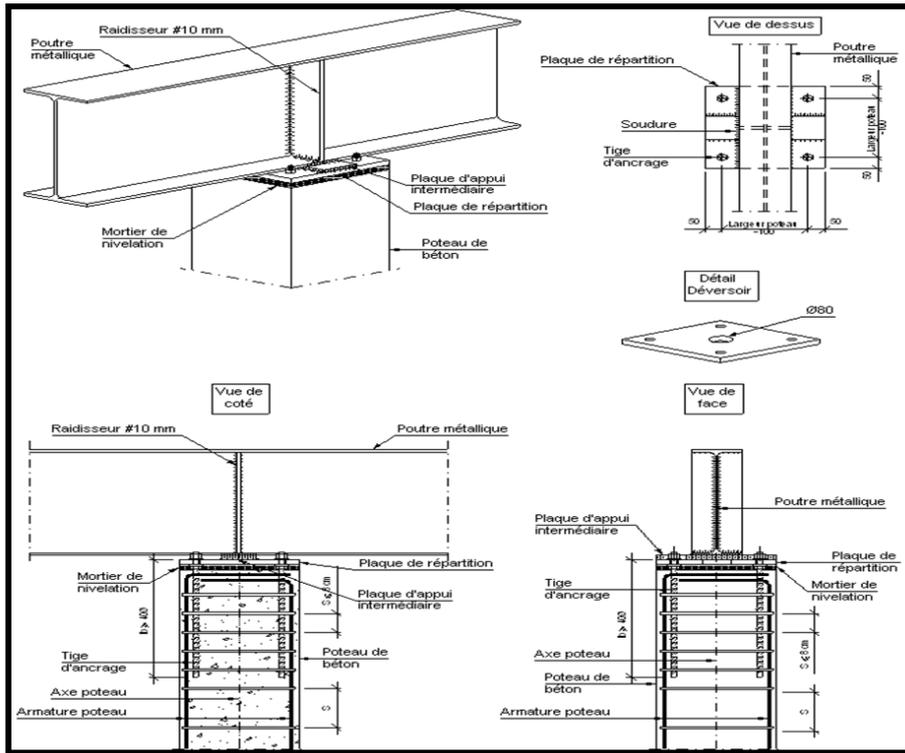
Appui d'une poutre métallique continue sur un poteau en béton
